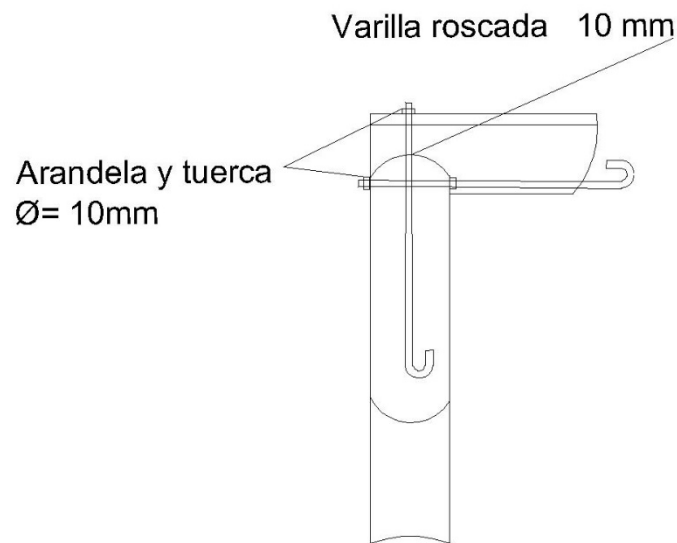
Detalle de unión viga- columna en las esquinas superiores del marco estructural del módulo.
